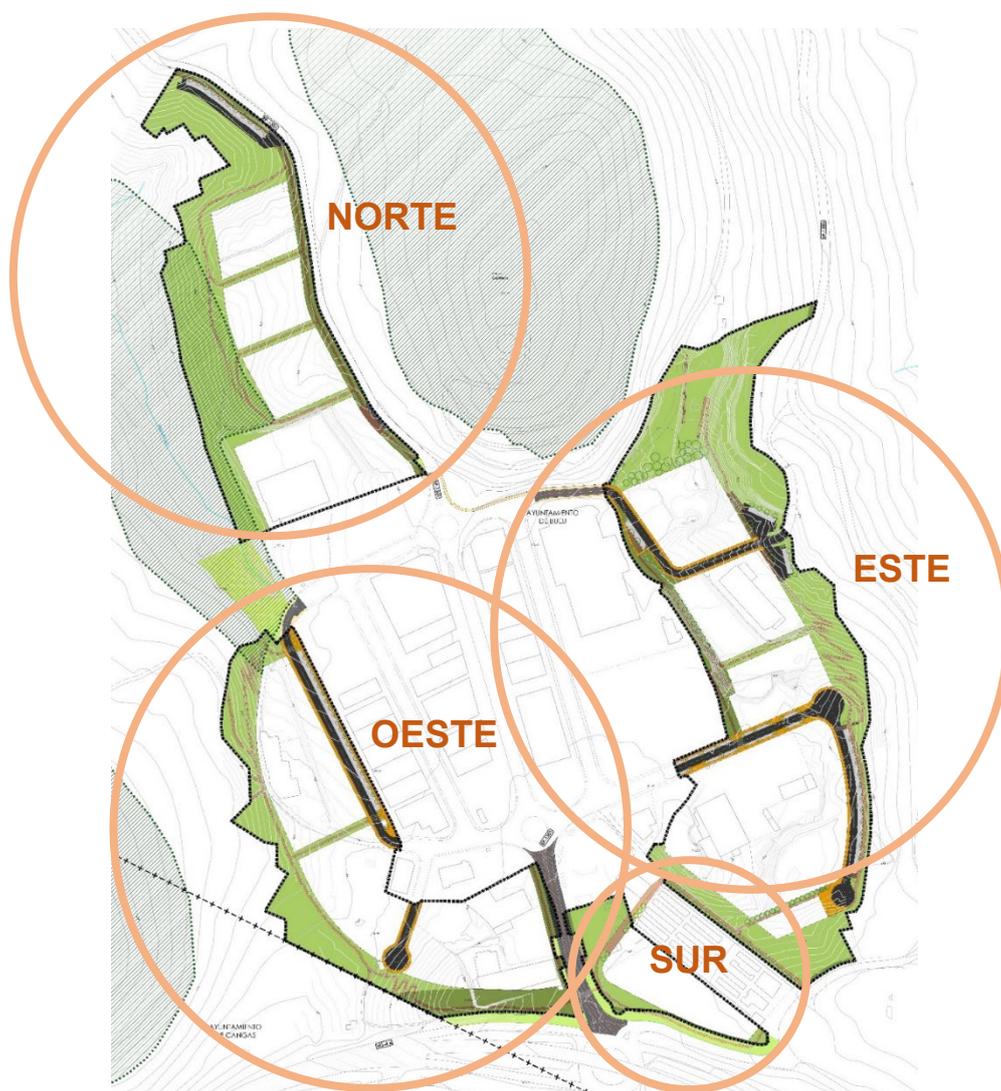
Plano donde se recoge la implantación topográfica, zonas verdes y viario
